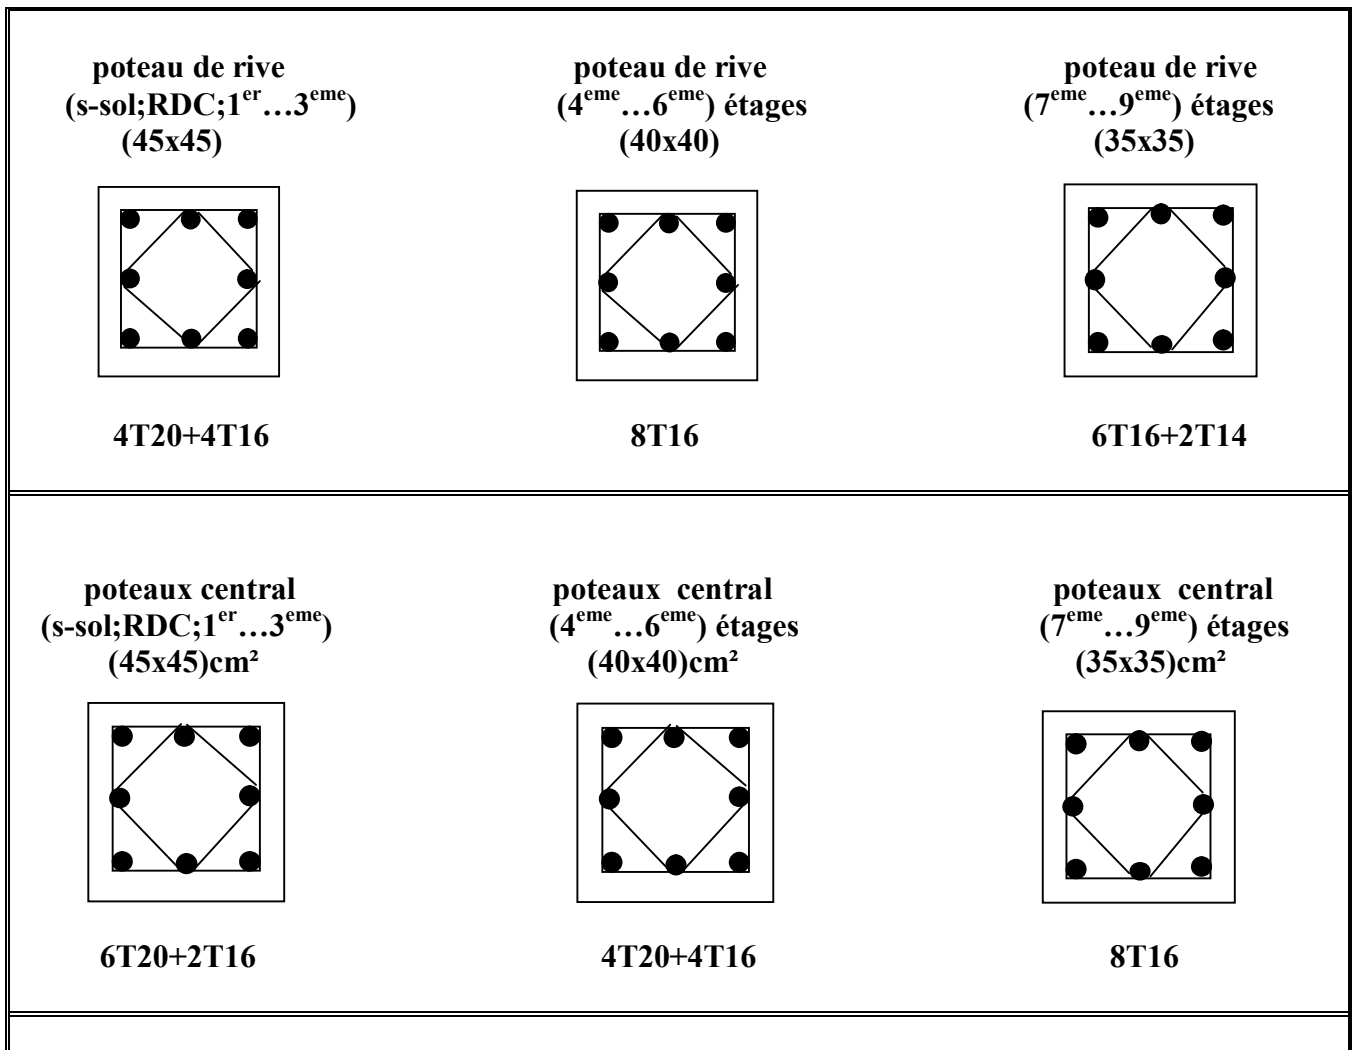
Dessin de ferrillages des sections des poteaux
